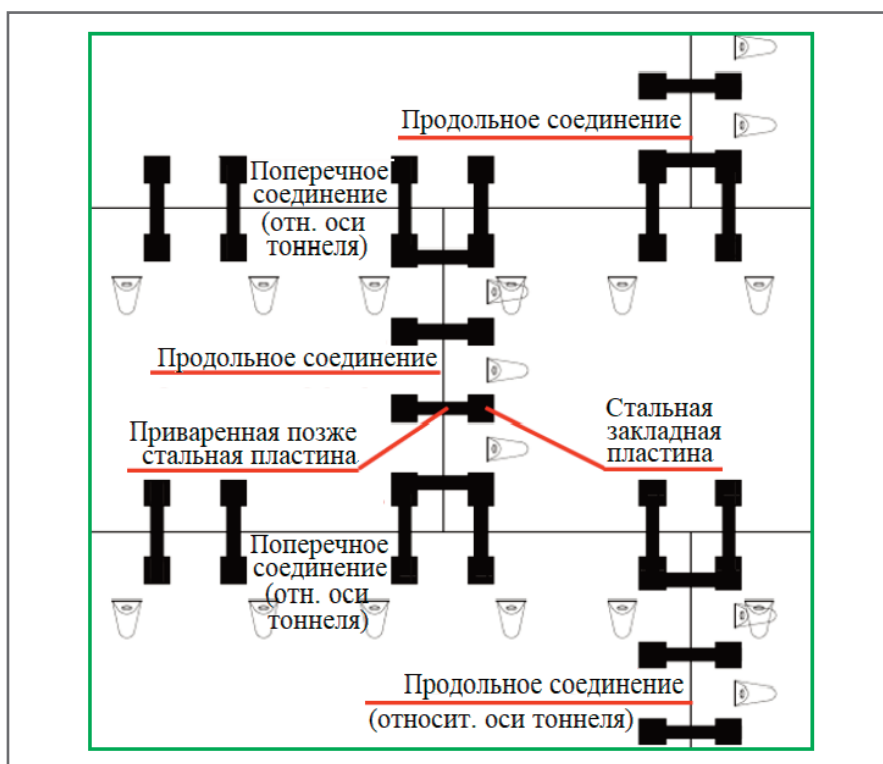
Схема сварки стальных пластин для соединения блоков внутри сегментного кольца
